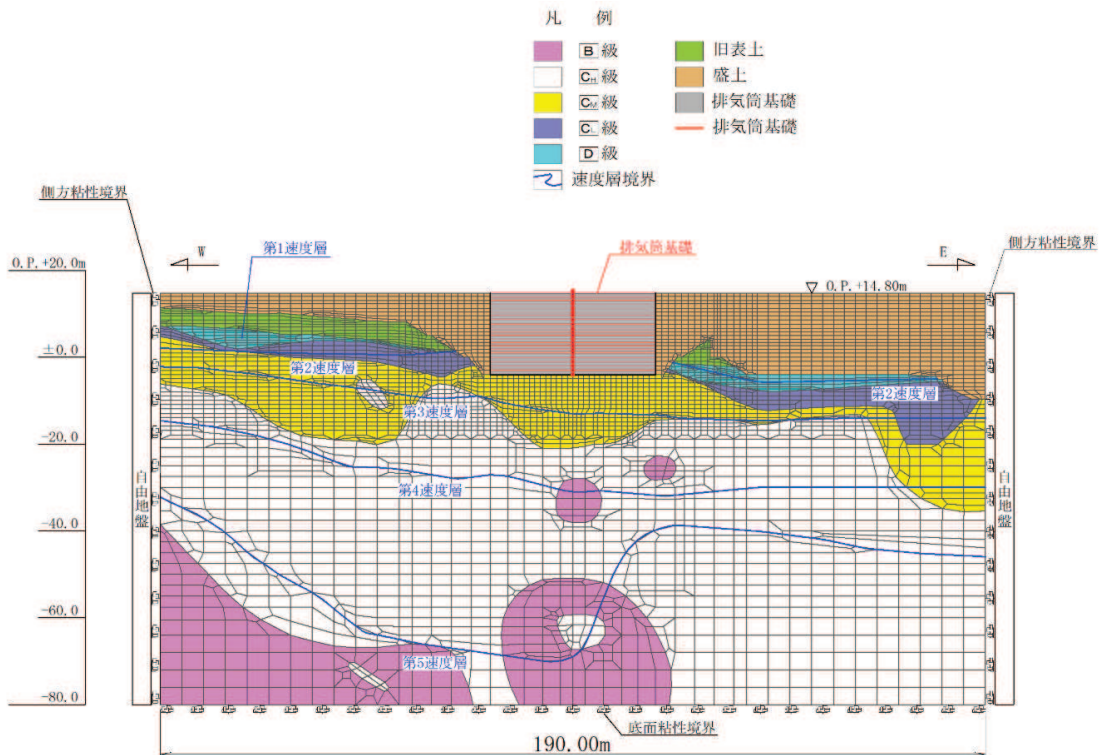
排気筒基礎の地震応答解析モデル図 (EW 断面)
